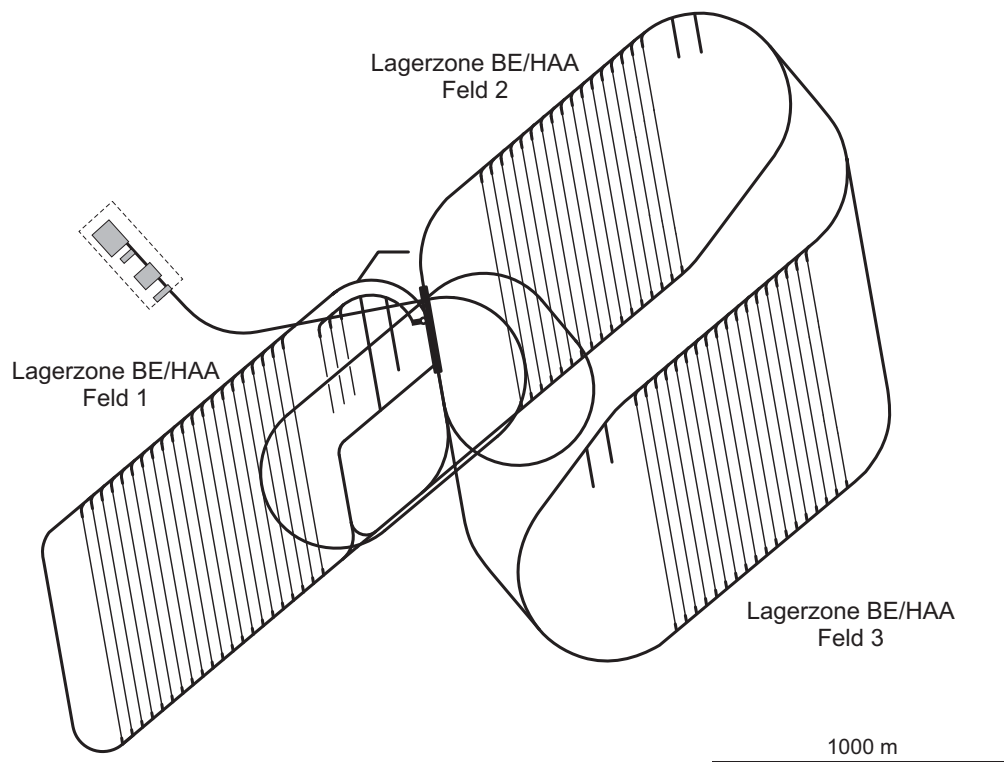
Modellhafter Grundriss zur Darstellung der Erweiterungsfähigkeit der Lagerkapazität des HAA-Lagers (60 Jahre Betrieb der bestehenden KKW und zusätzlich Produktion von 5 GW_e während 60 Jahren).
